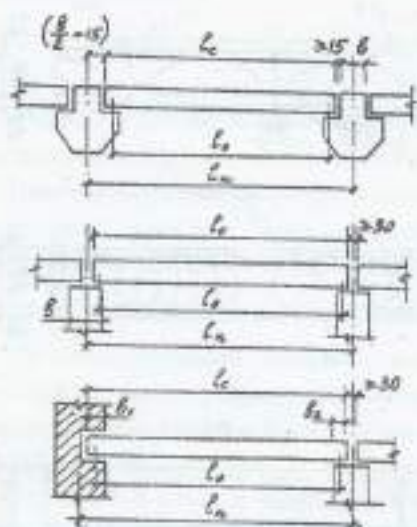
Привязка сборных плит перекрытия к разбивочным осям несущих конструкций
